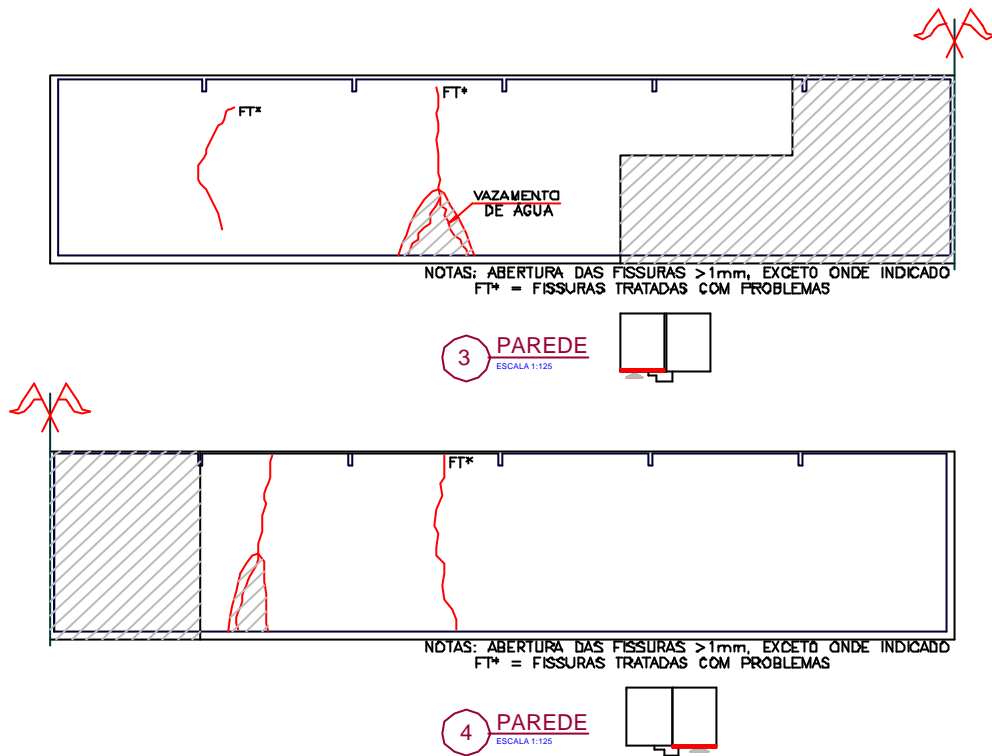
Mapeamento de fissuras nas paredes 3 e 4. (CHIMELLO, 2000).
